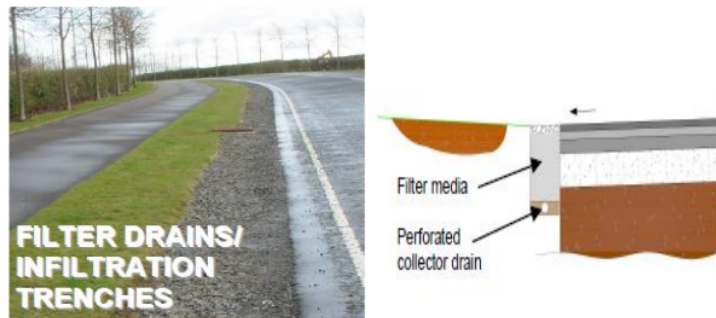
Model Drainase Filter Drains – Infiltration Trenches (SCOTS and SUDS Working Party, 2007)
